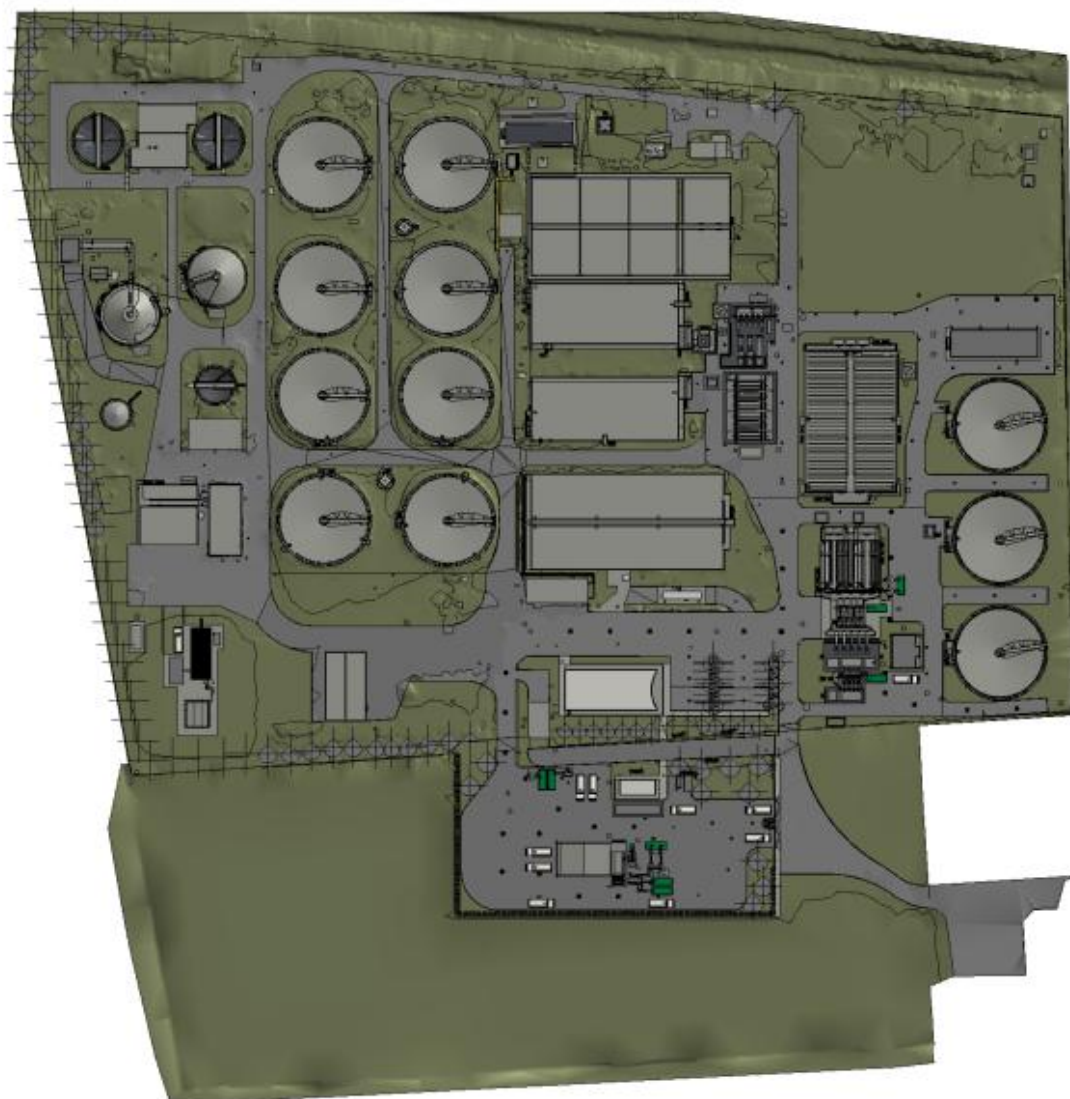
Layout stato di progetto impianto di depurazione di Ravenna
